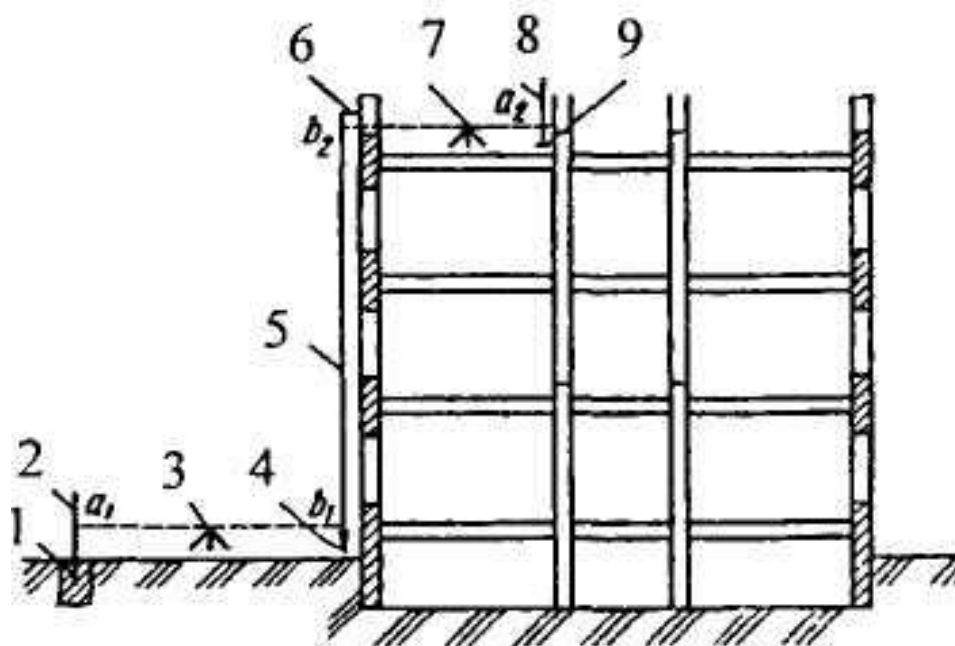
Схема переноса отметки на монтажный горизонт: 1 — строительный репер; 2, 8 — рейки; 3, 7 — нивелиры; 4 — дополнительный пригруз рулетки; 5 — рулетка; 6 — кронштейн; 9 — рабочий репер; а и Б — отсчеты по нивелирам
